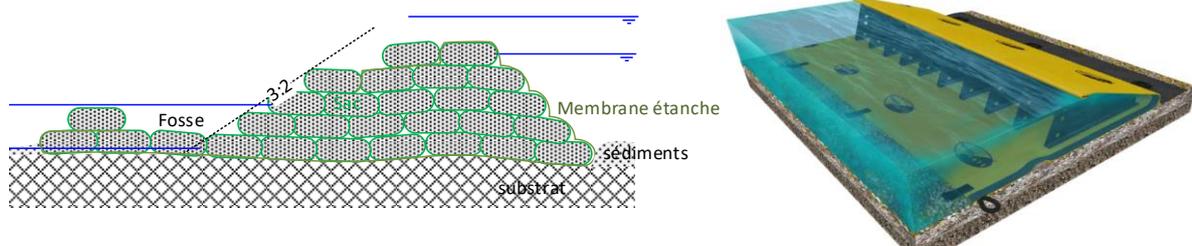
Coupe transversale du seuil en mur poids (à gauche) et illustration et d'une barrière amovible (à droite, WaterGate© - MegaSecure)
